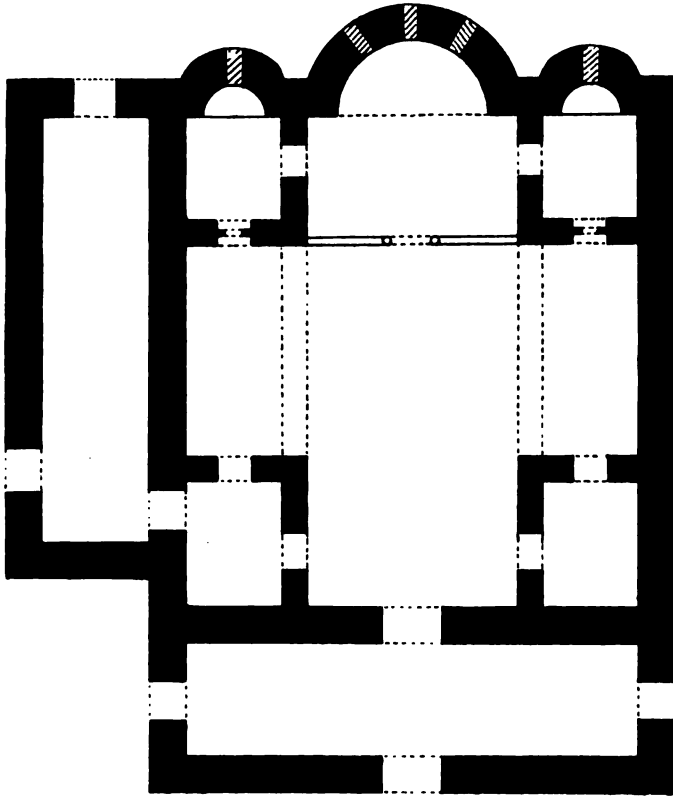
Grundriss-Skizze des Protaton.
